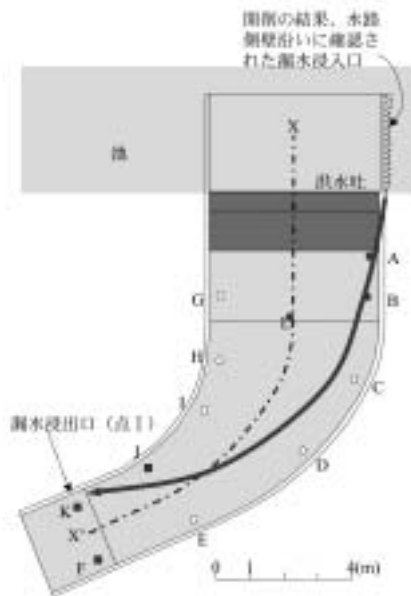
洗沢ため池洪水吐および洪水吐水路の平面図
